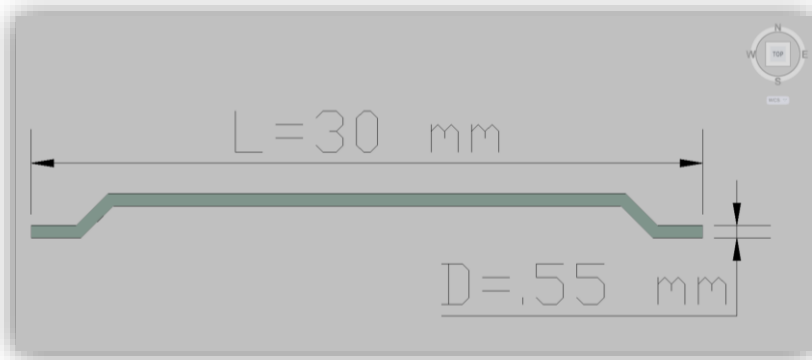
Geometría de la fibra de acero utilizada como refuerzo en las vigas ensayadas
